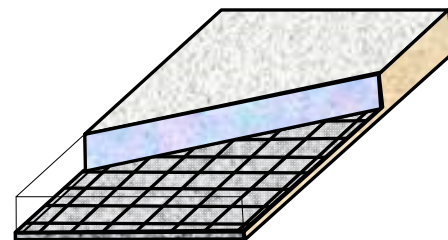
Сплошная прямоугольная плита, армированная сеткой
